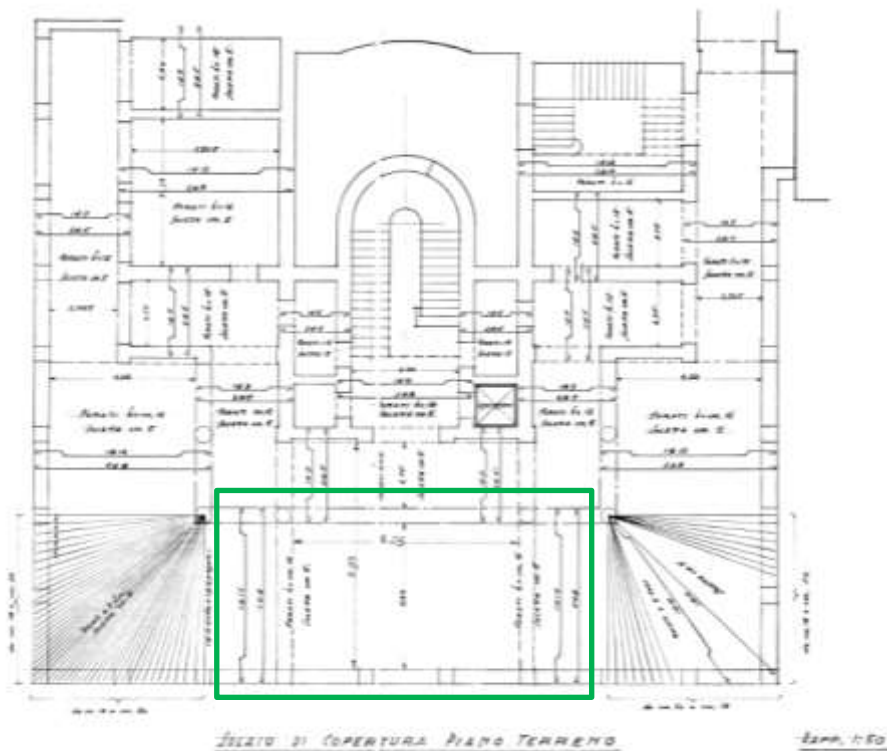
Pianta solaio di copertura piano terra (da progetto preliminare), con indicazione delle travi in c.a.
